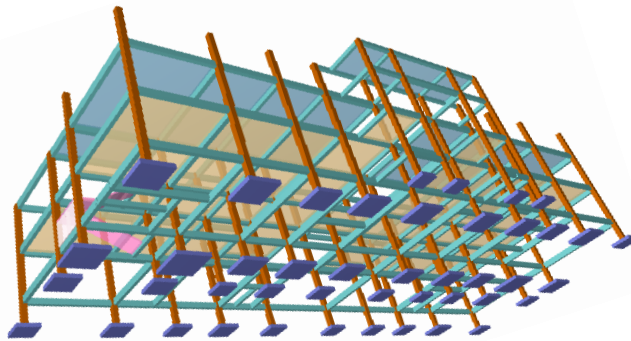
Estructura idealizada Zapatas (Fuente: Elaboración Propia)
